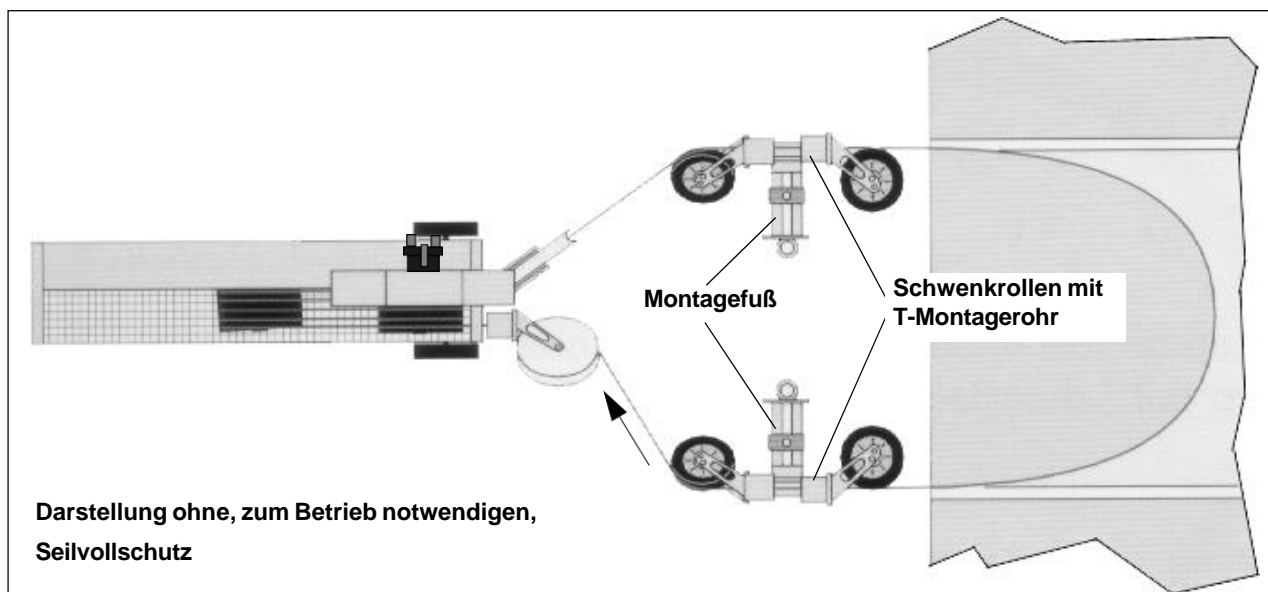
Seilsägeanlage, -automat (CSA•1000) für horizontalen (waagerechten) Schnitt aufgebaut (Draufsicht)
